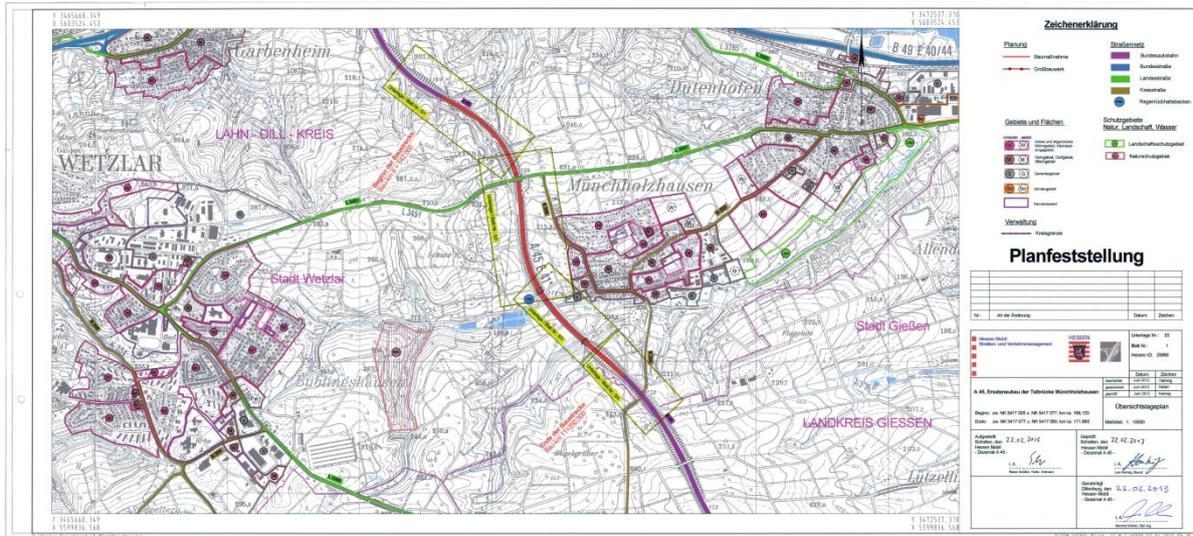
Übersichtslageplan – Talbrücke Münchholzhausen © Planfeststellungsunterlagen – Hessen Mobil
